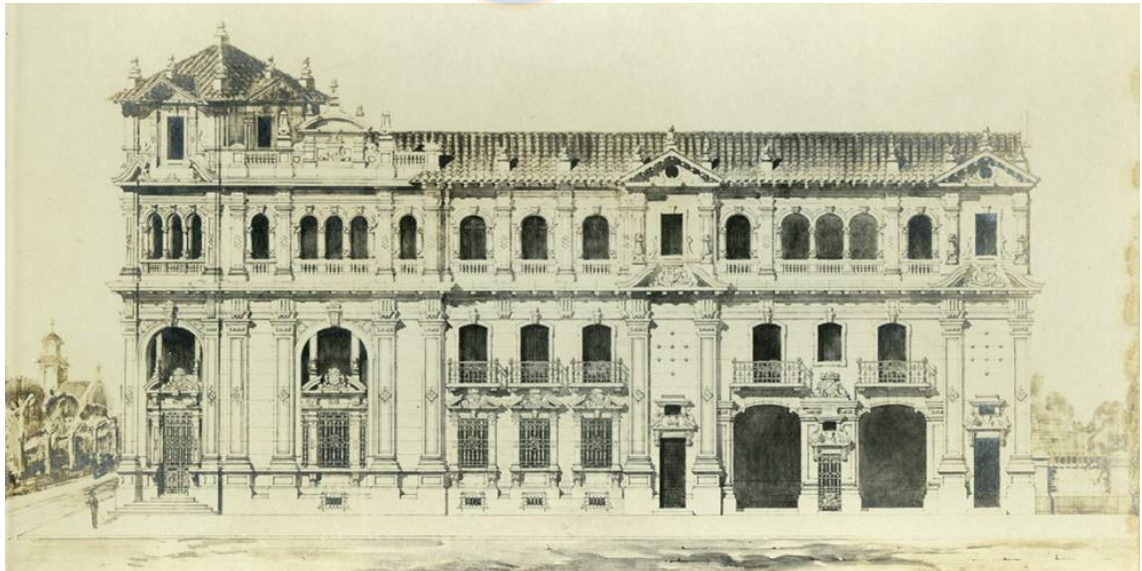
Elevación proyecto Caja Nacional de Ahorros, Concepción.
